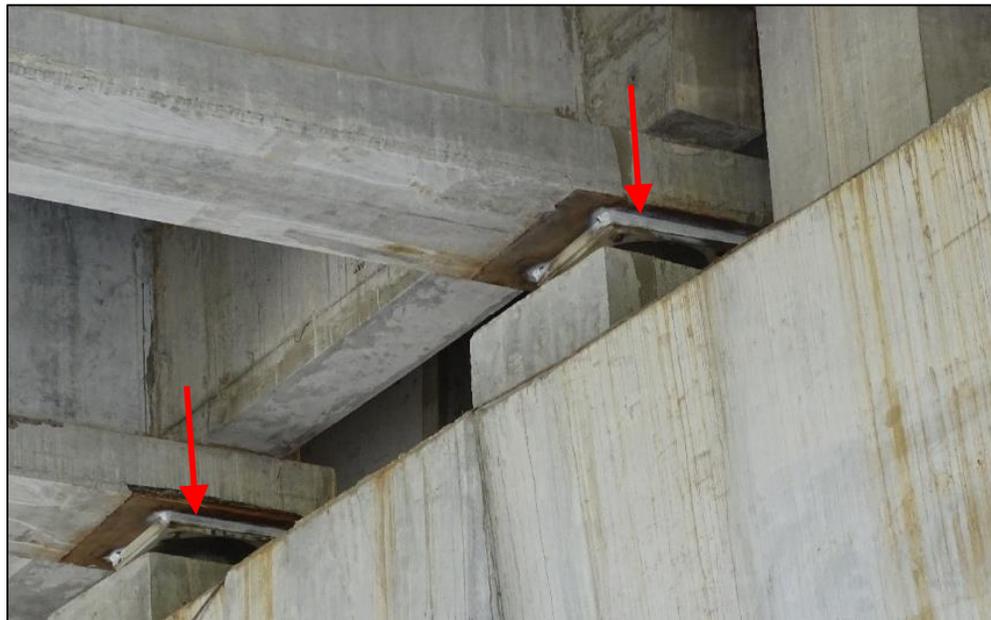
Sistema de protección aplicado a los cordones de soldadura que unen el dispositivo de aislamiento sísmico con la placa de acero superior.
